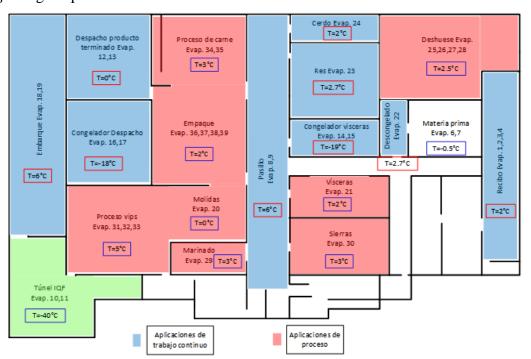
Plano de distribución de aplicaciones y sus condiciones de operación de la planta.
